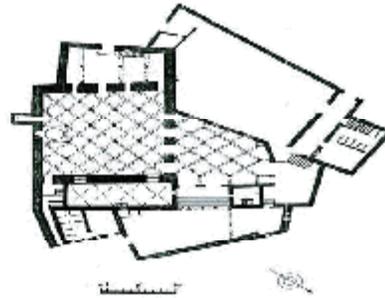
مسقط أفقي لجامع القصبة بتونس، عن:
